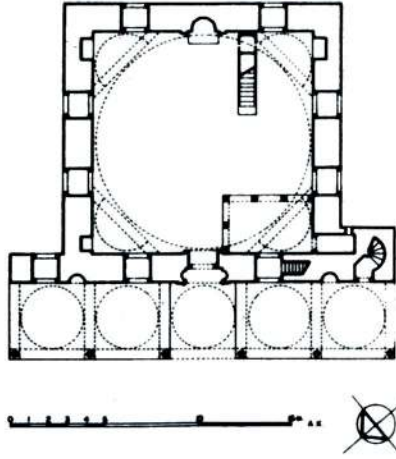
Bursa Abdal Mehmed Camii planı (E.H. Ayverdi'den)
